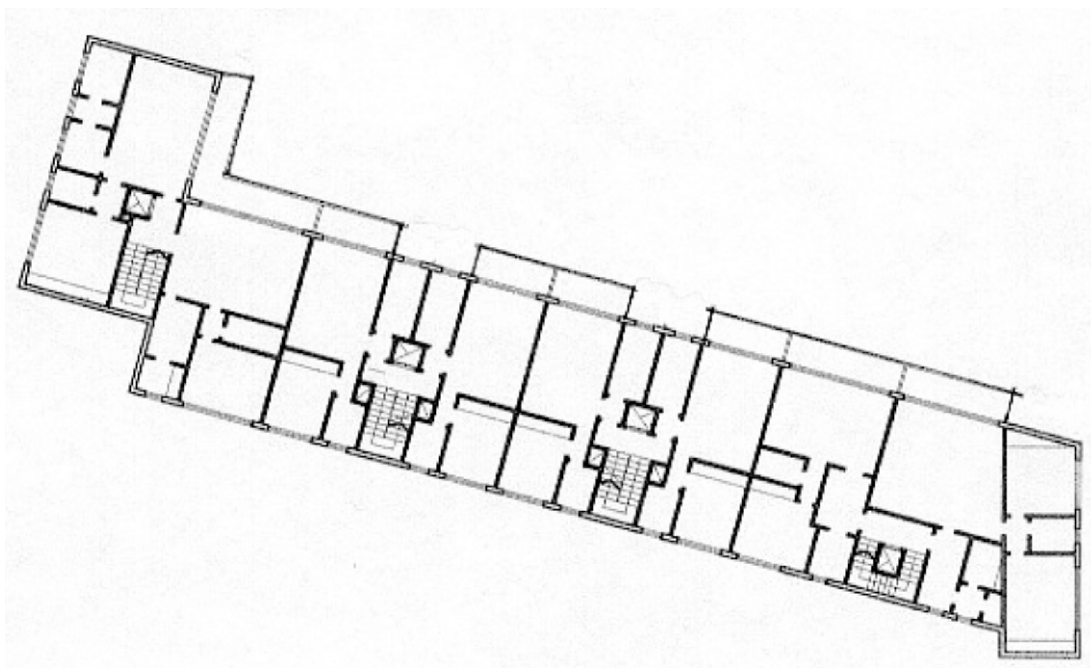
Plantas tipo edificio San Francisco IV. Fuente: Archivo de Obras Privadas, Municipalidad de General Pueyrredón.
